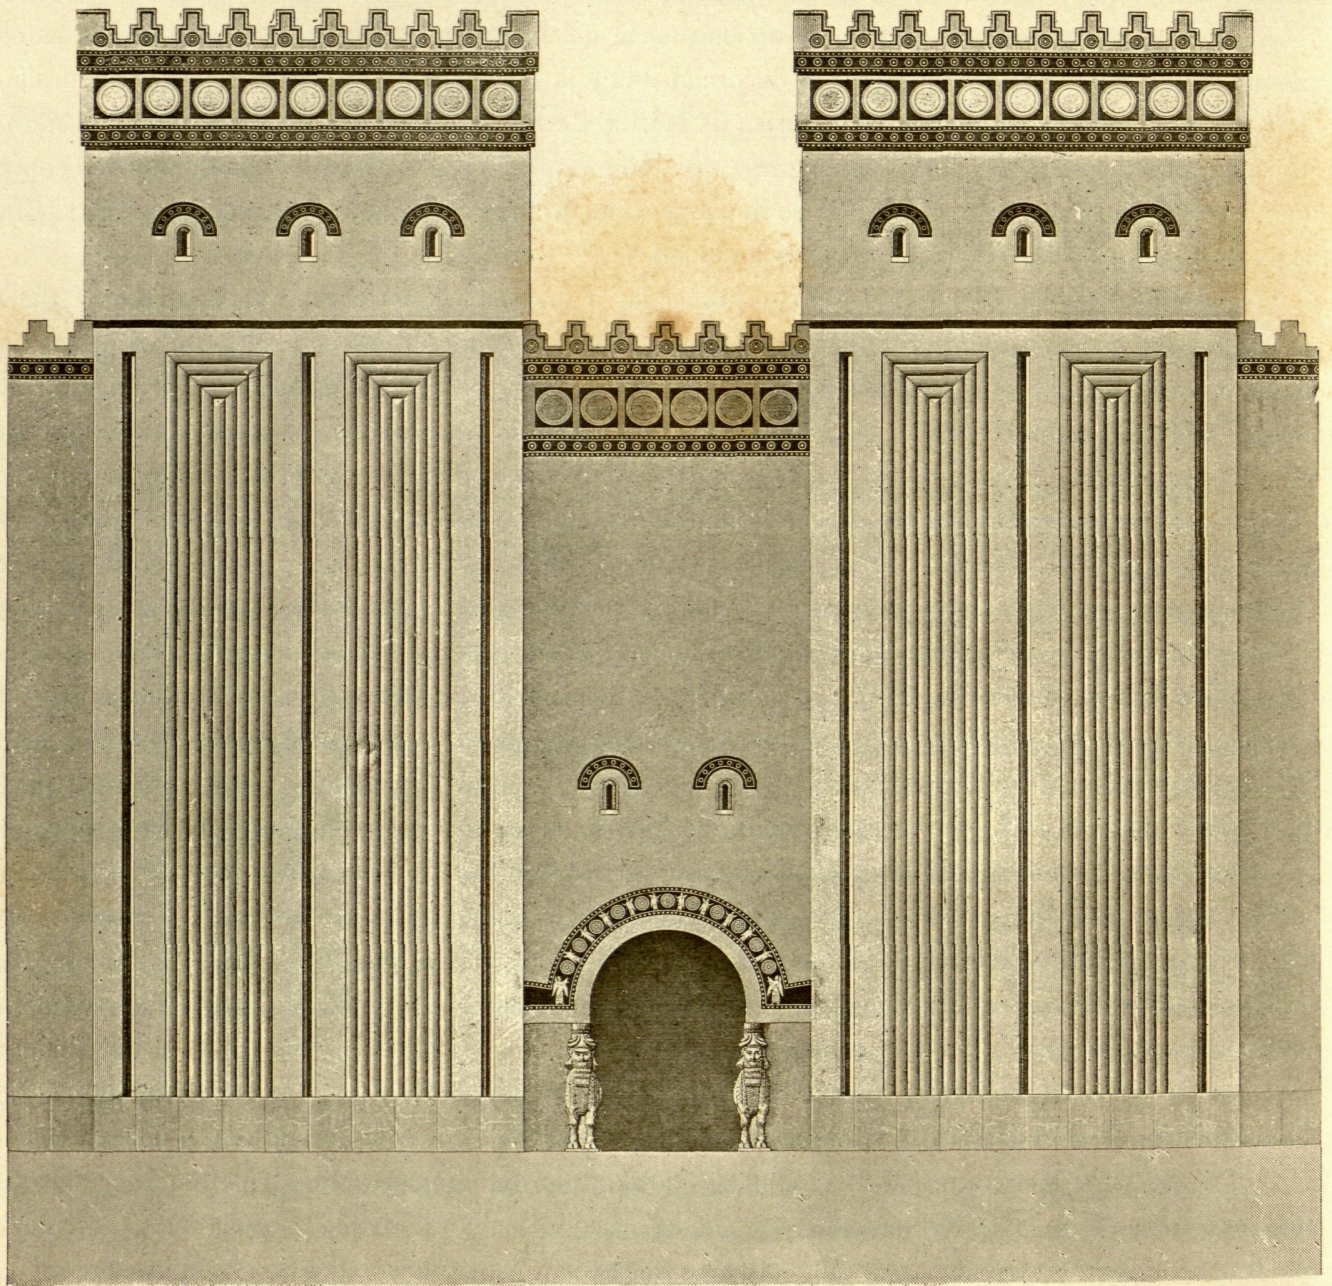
ALZADO GENERAL DE UNA PUERTA DE LA CIUDAD DE SARGÓN (KHORSABAD). — ENSAYO DE RESTAURACIÓN DE THOMAS
